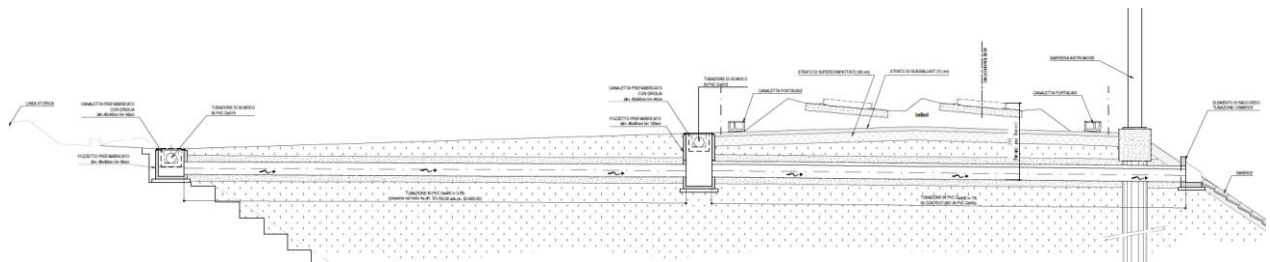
Dettaglio di scarico della canaletta rettangolare posta nell'area interclusa tra linea di progetto e linea storica.
